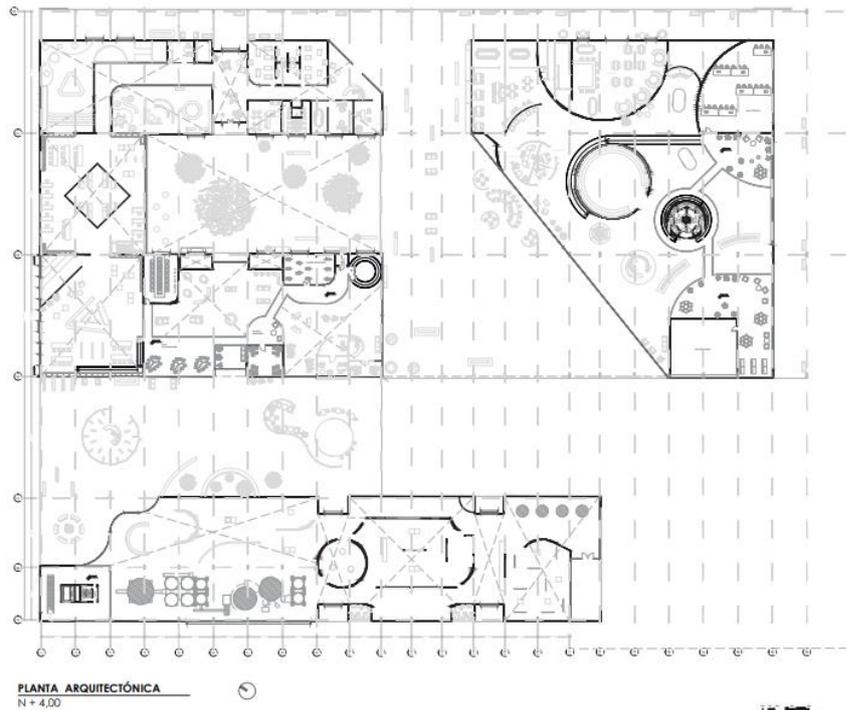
Planta arquitectónica N+4.00 Escuela de Artes - Museo
